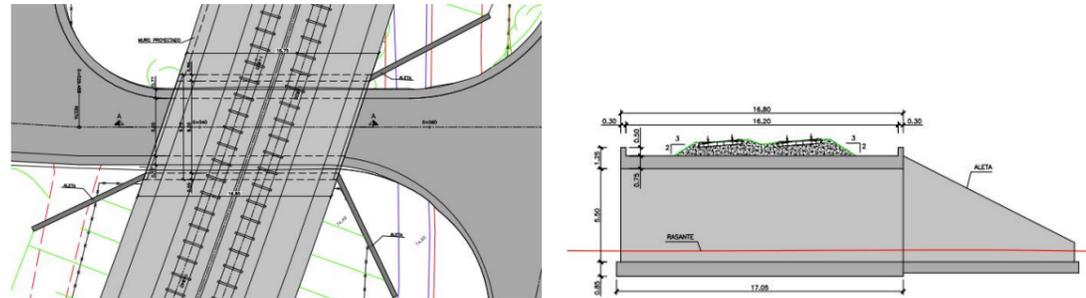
PLANTA Y ALZADO DEL PASO INFERIOR P.K. 1+820
